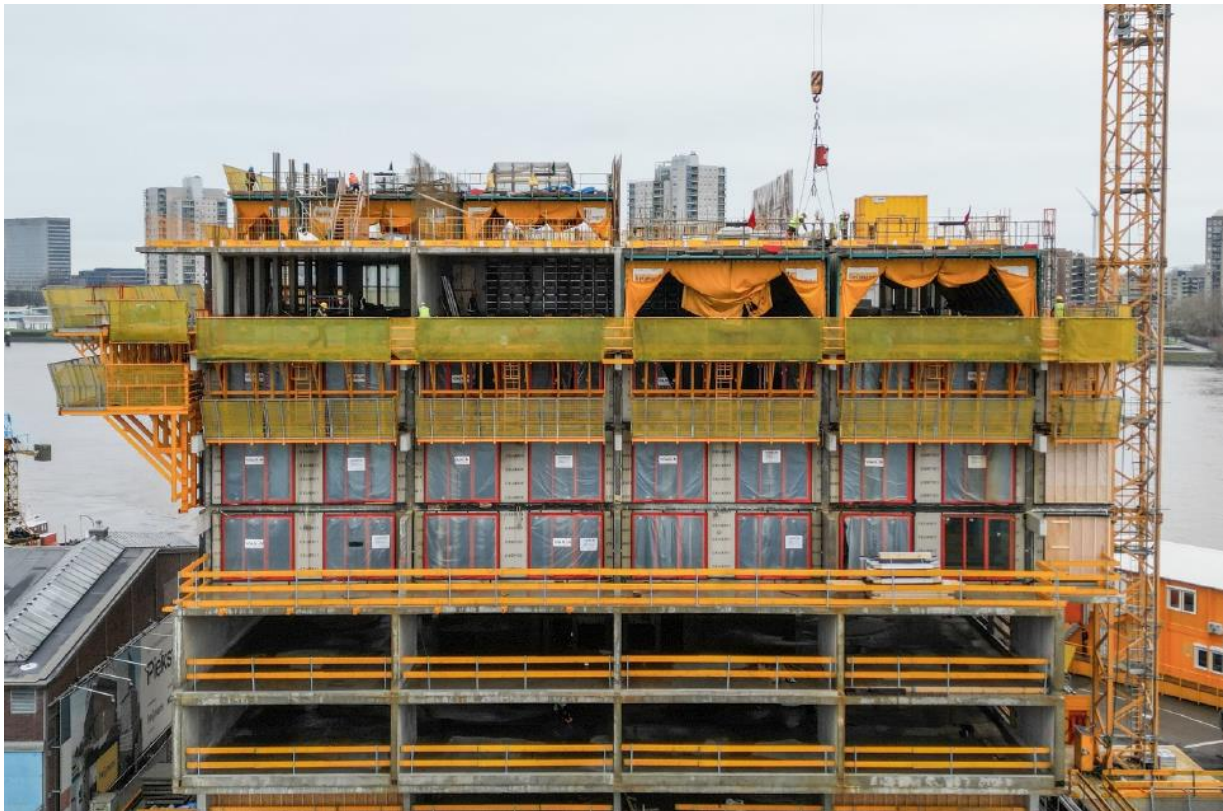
Piekstraat in uitvoering. Er wordt op vier niveaus tegelijk gewerkt
